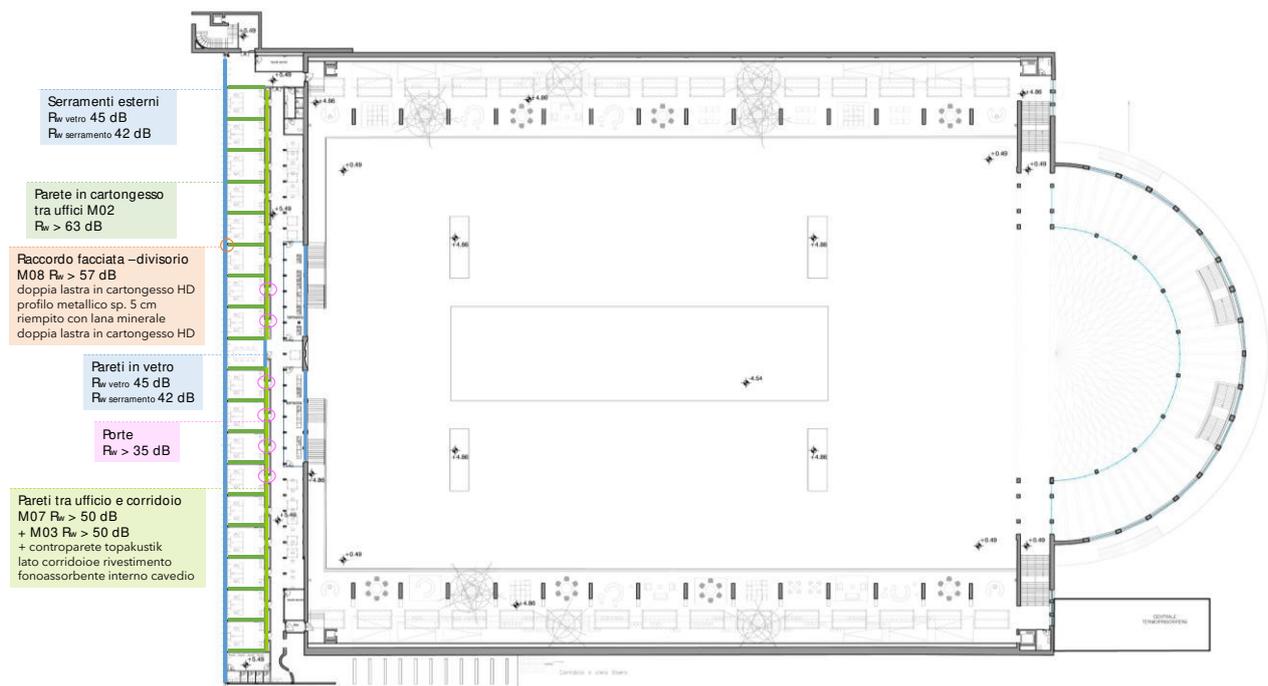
Stato di progetto. Definizione delle prestazioni dei componenti edilizi. Piano primo.
